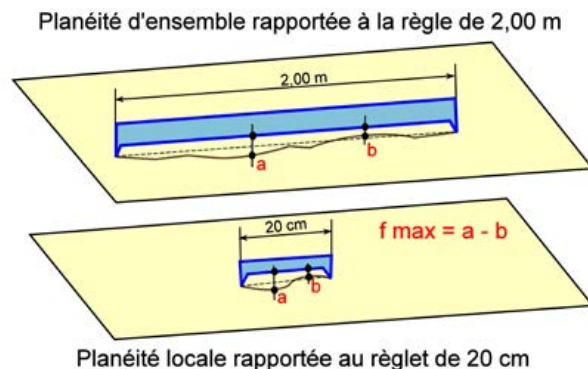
contrôle à la règle et au réglet de la planéité d'une paroi en béton
